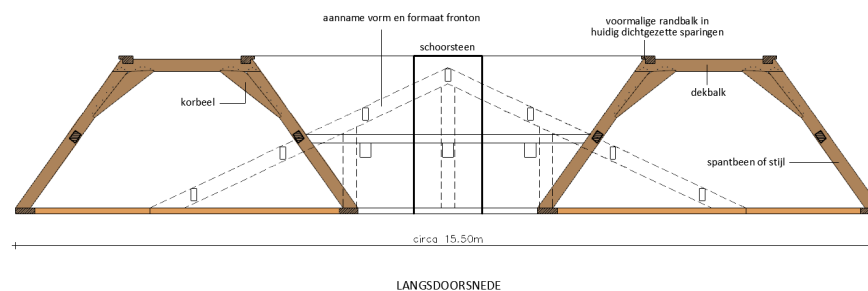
Reconstructie dakconstructie Blokhuisen aan de hand van doorsneden zoldergebinten OZ/Huiszittenhuis en ontwerptekening in afbeelding 5.25
